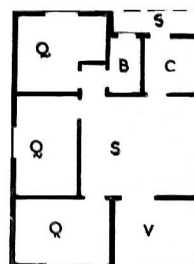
Planta da unidade. Fonte: PEREIRA, 1991.
